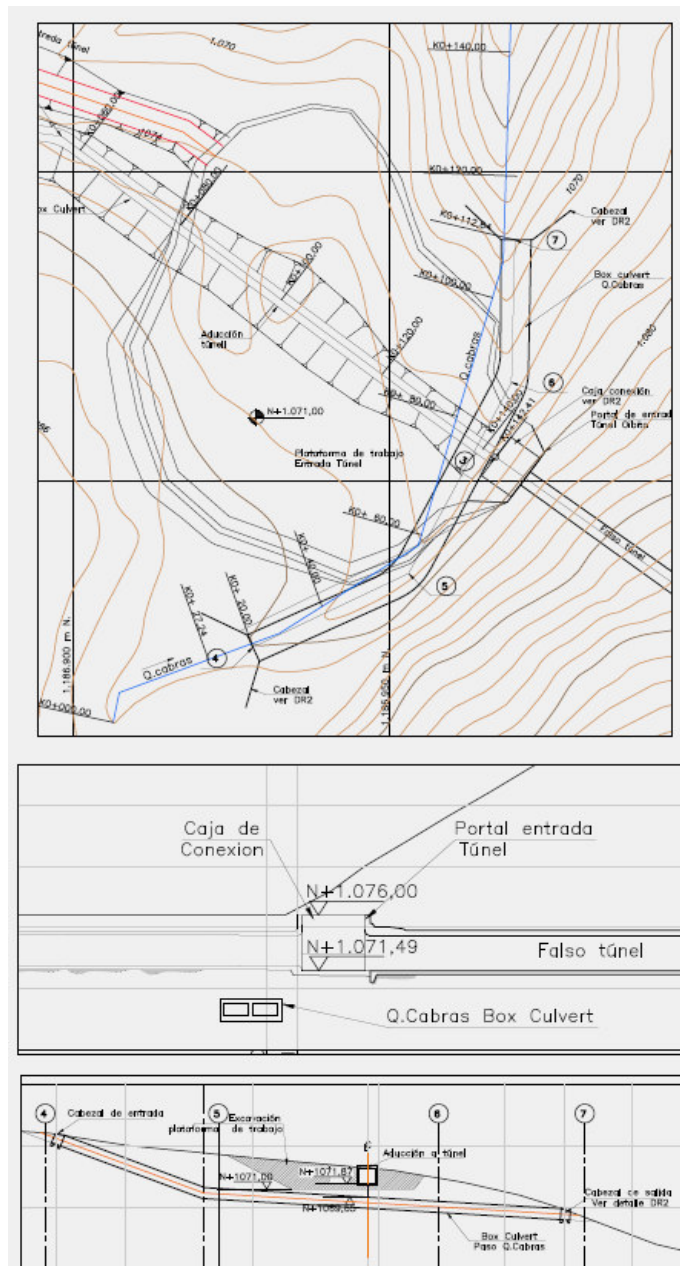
Planta perfil de Box Coulvert en portal de entrada del t nel
